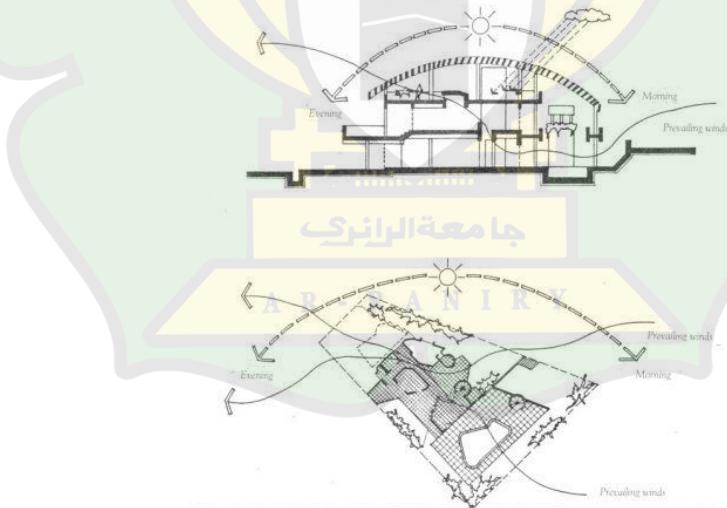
32 Gambar Potongan *The Roof-roof House
